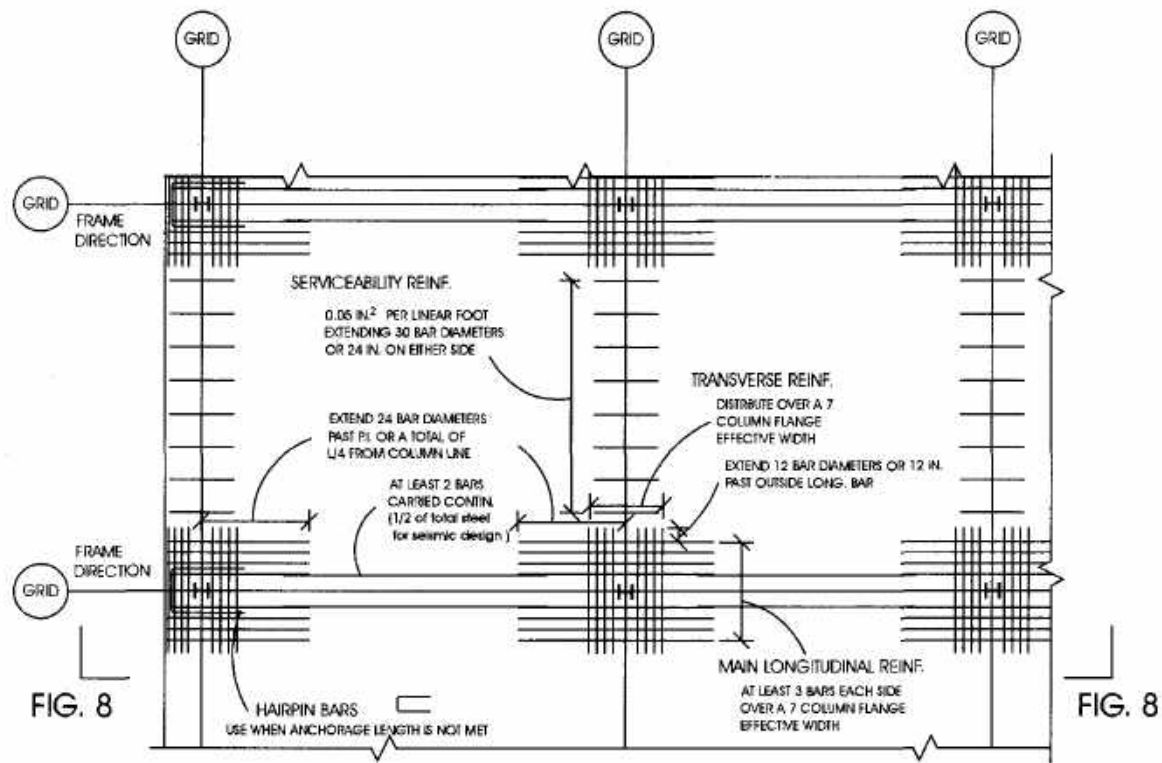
Requerimientos de detalle (vista en planta). (León, Hoffman y Staeger 1996)
